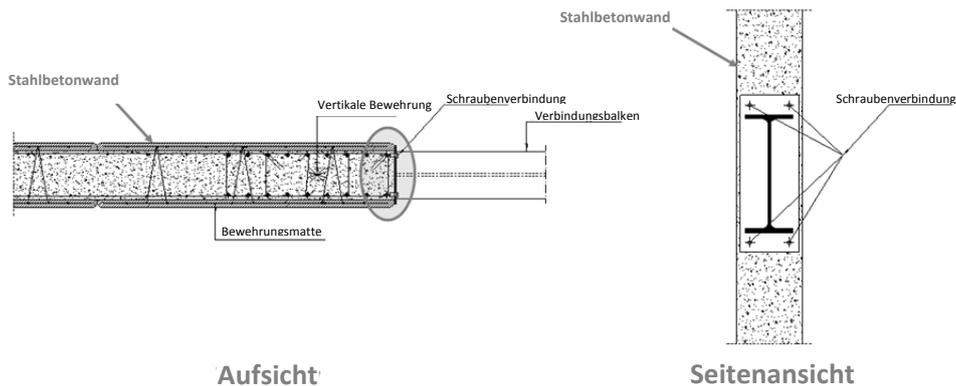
Typische Verbindung zwischen Stahlstruktur und Stahlbetonwand, die sowohl horizontale als auch vertikale Lasten übertragen kann.
